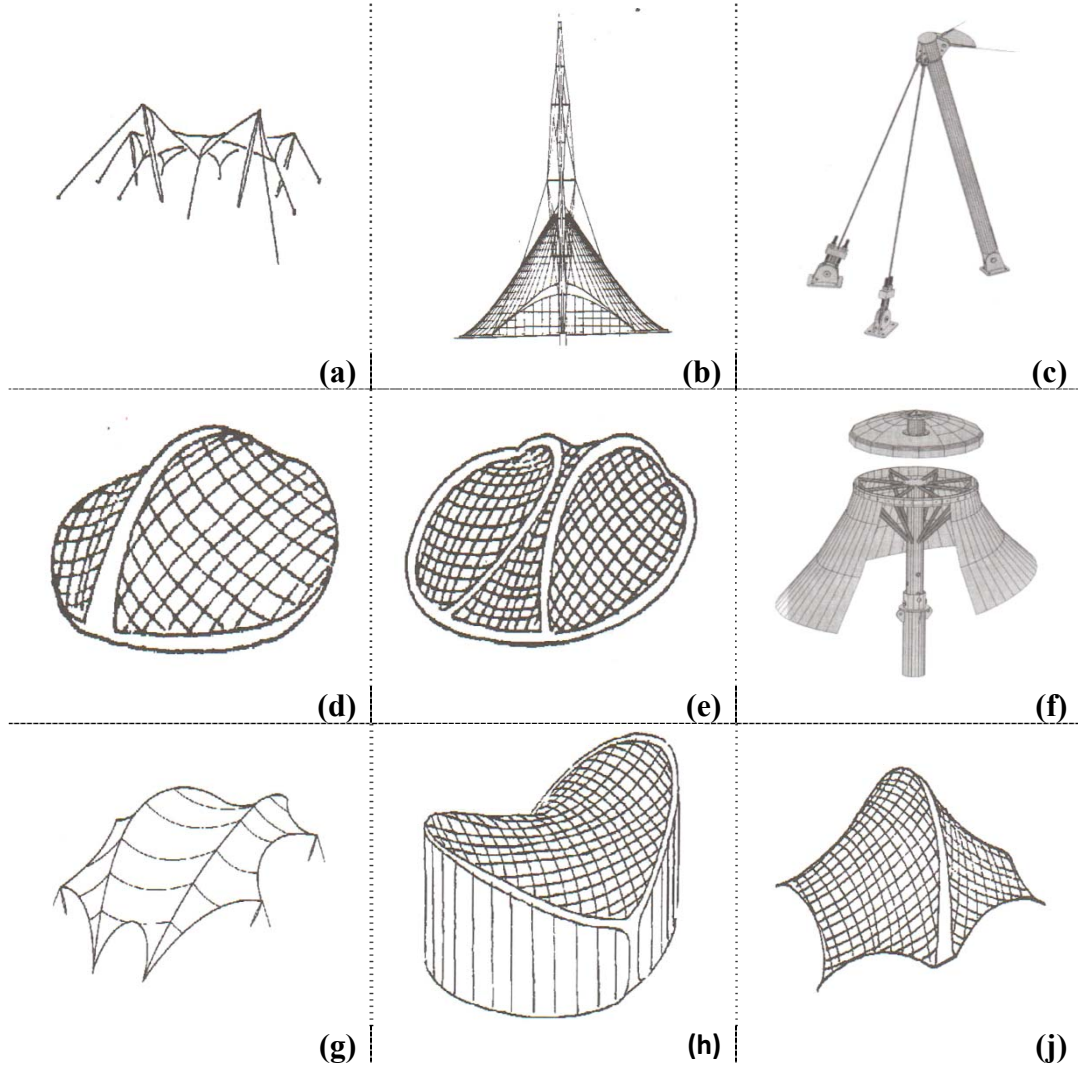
h’de betonarme perde duvar örneği yer almaktadır.
